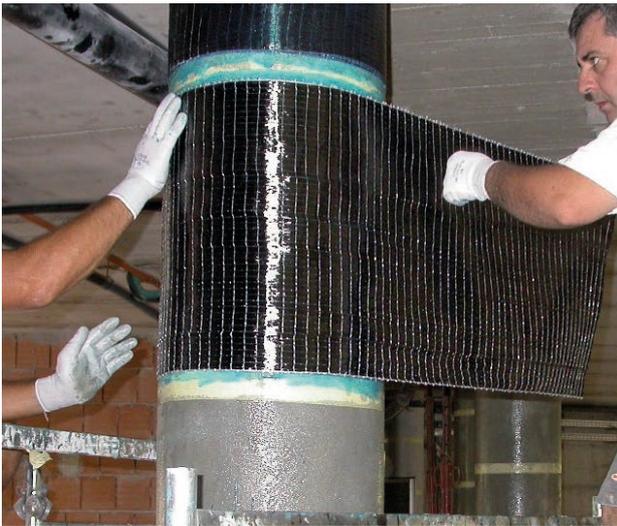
Confinamento pilastro in cemento armato con SikaWrap® FIB
